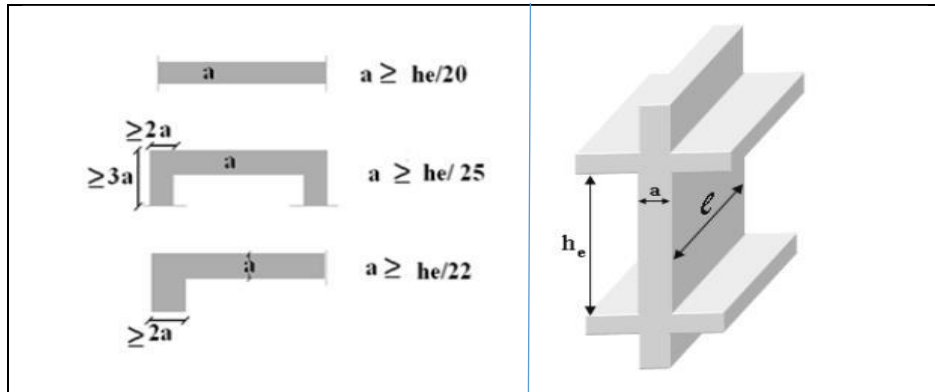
coupe d'un voile en plan / Coupe d'un voile en élévation.
